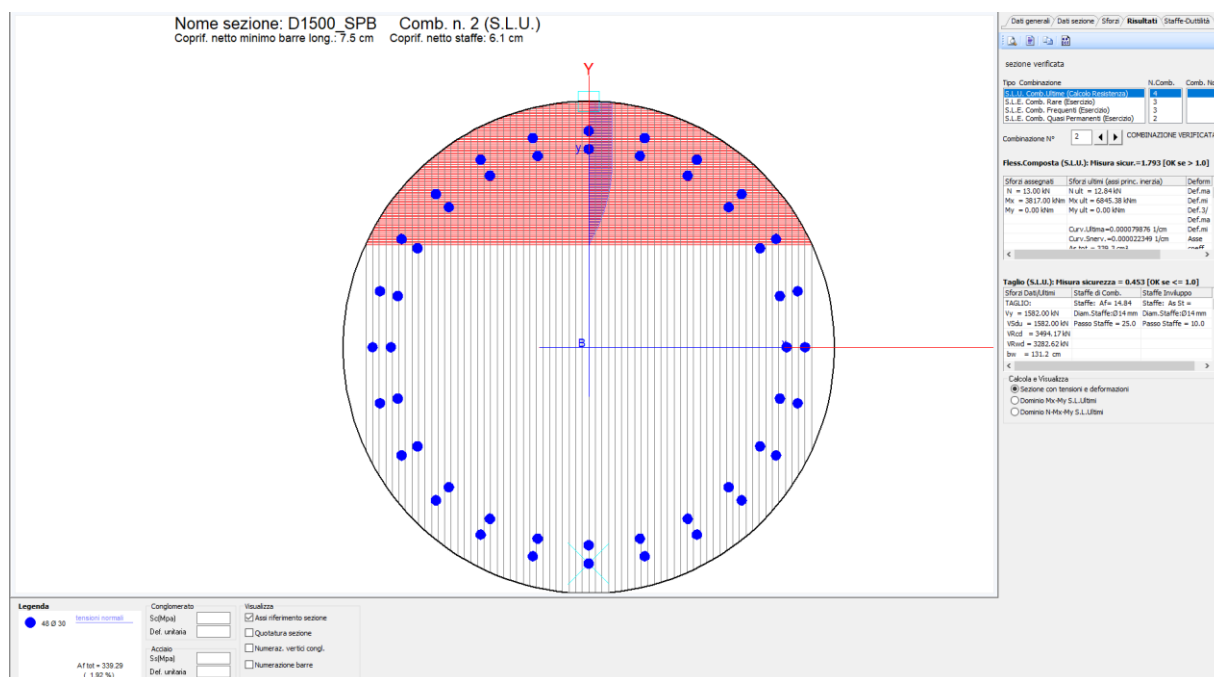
Verifica strutturale palo D1500mm – spalla B
